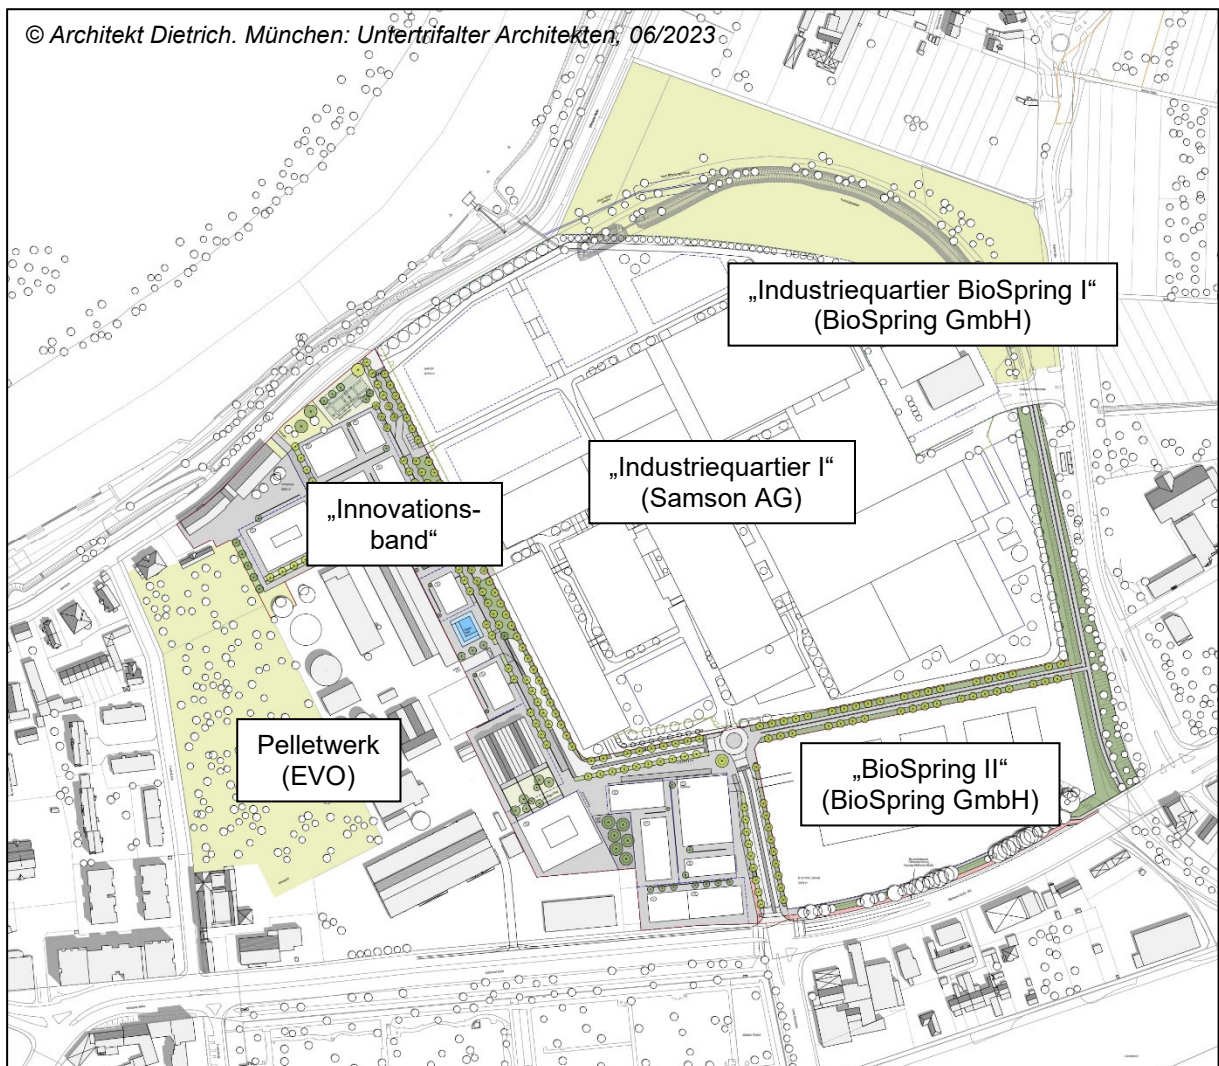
Vorentwurf Lageplan städtebaulicher Entwurf
